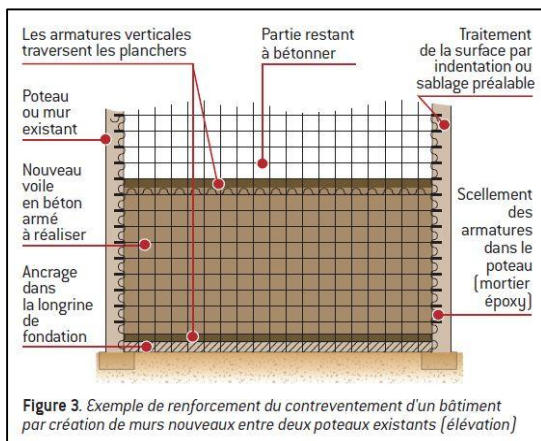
Exemple de renforcement du contreventement d'un bâtiment par création de murs nouveaux entre deux poteaux existants (élévation)
